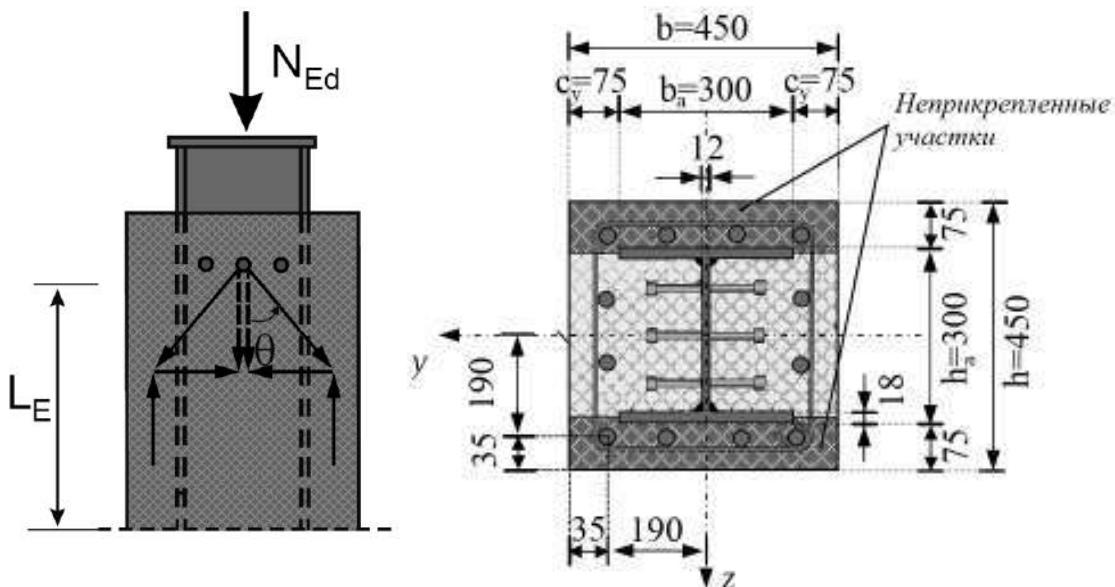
Пример расчета поперечного армирования из условия передачи усилий продольного сдвига в оголовке колонны
